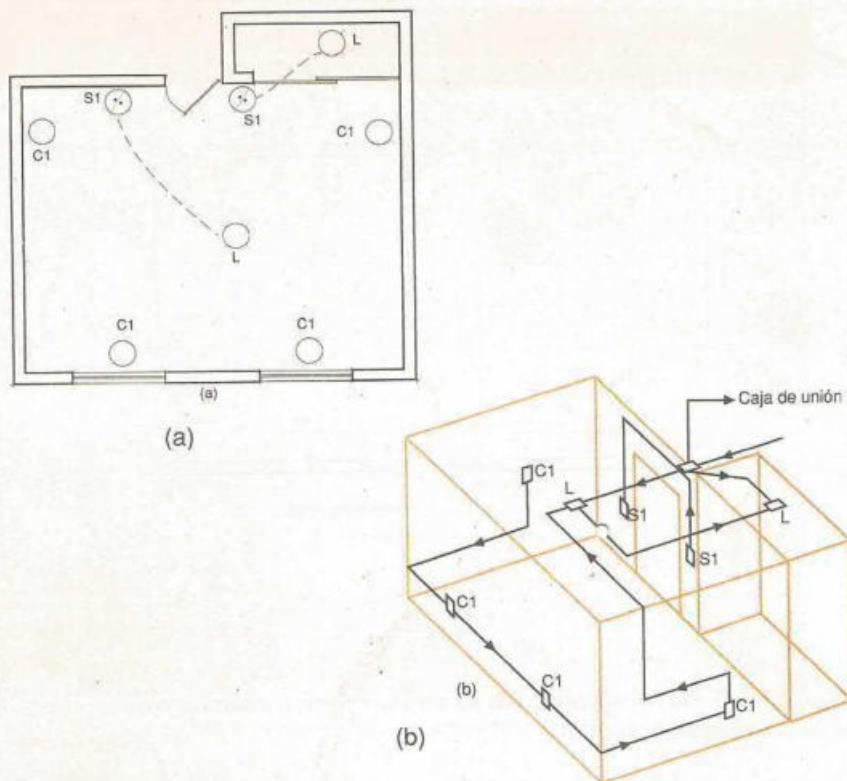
Alambrado de una recámara con closet (a) Plano de planta; (b) Plano isométrico
